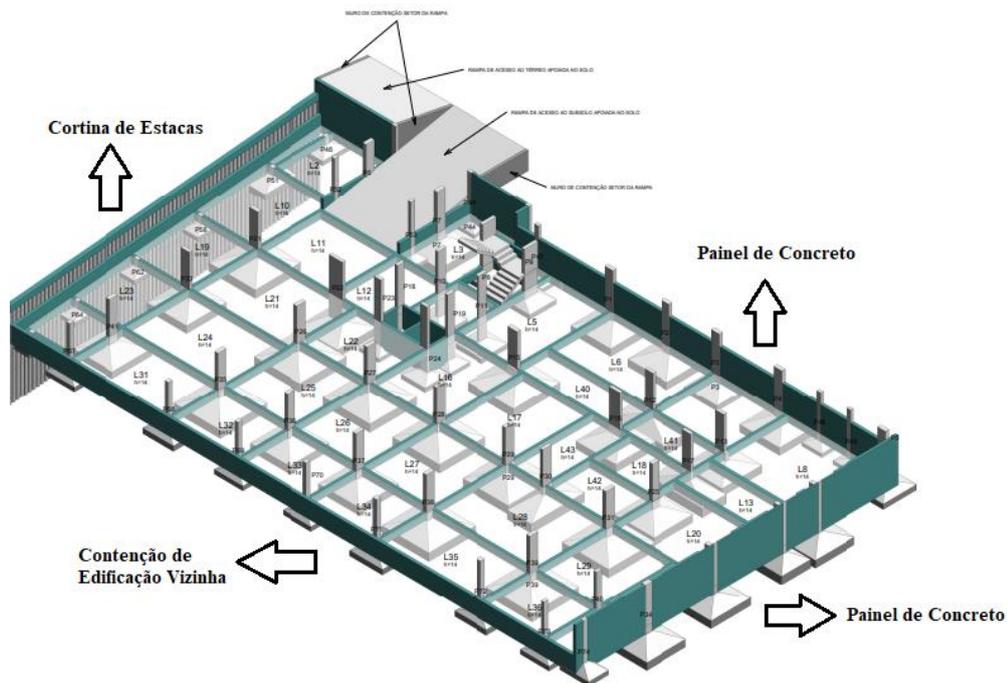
Subsolo em 3D com contenções, sapatas e vigas baldrame
